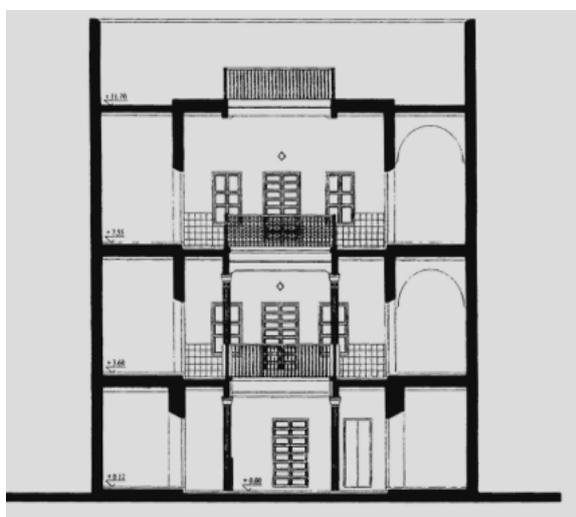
Schnitt durch den Hofbereich des Hauses Dar Azouz und Fassadenansicht
